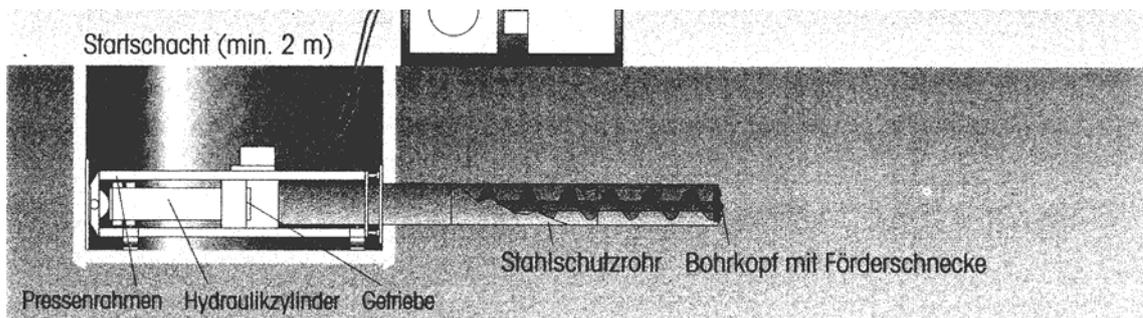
Vorpressen der Schutzrohre und Fördern des Erdreiches [1]
